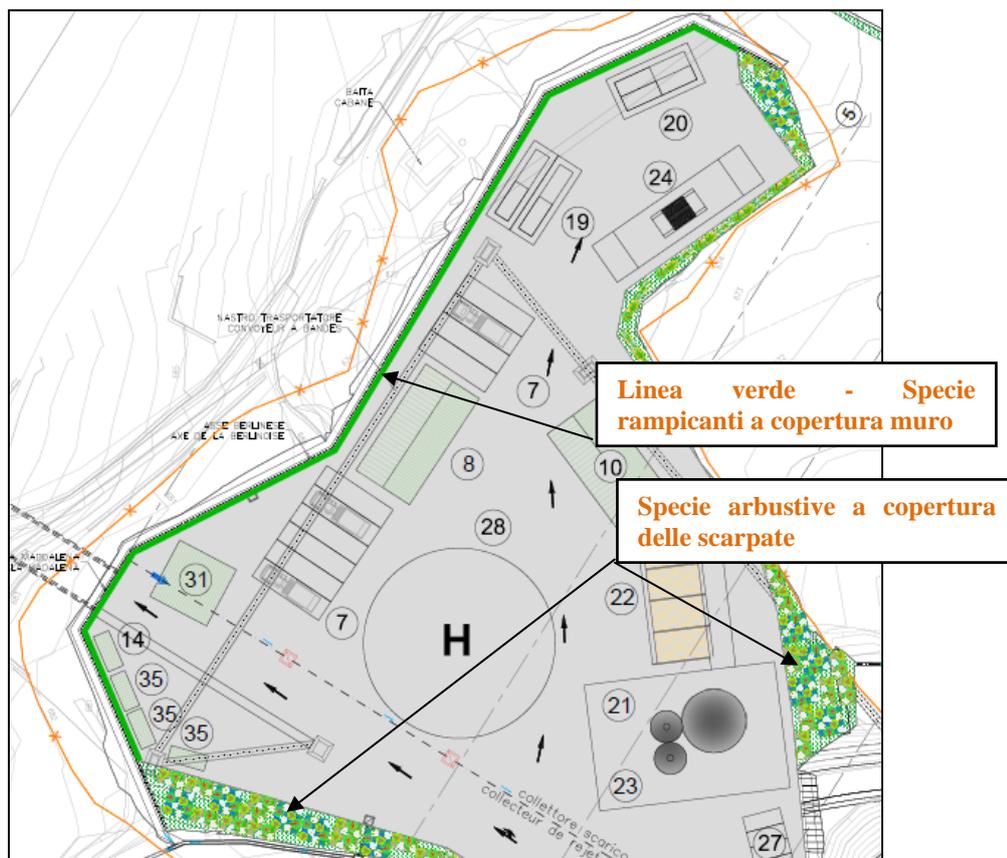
INGRANDIMENTO 2: Indicazione con linea verde del muro della berlinese schermato con specie rampicanti e disposizione di moduli arbustivi sulle scarpate perimetrali
